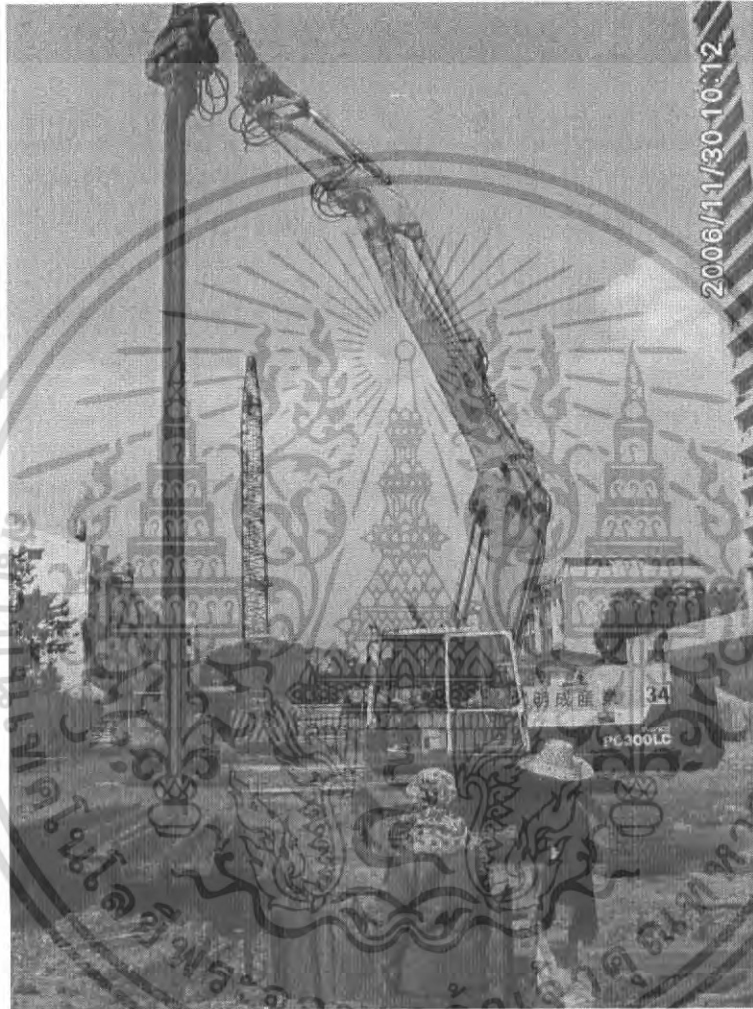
แสดงการนำ sheet pile มาวางเป็นแนวเพื่อทำการตอก
